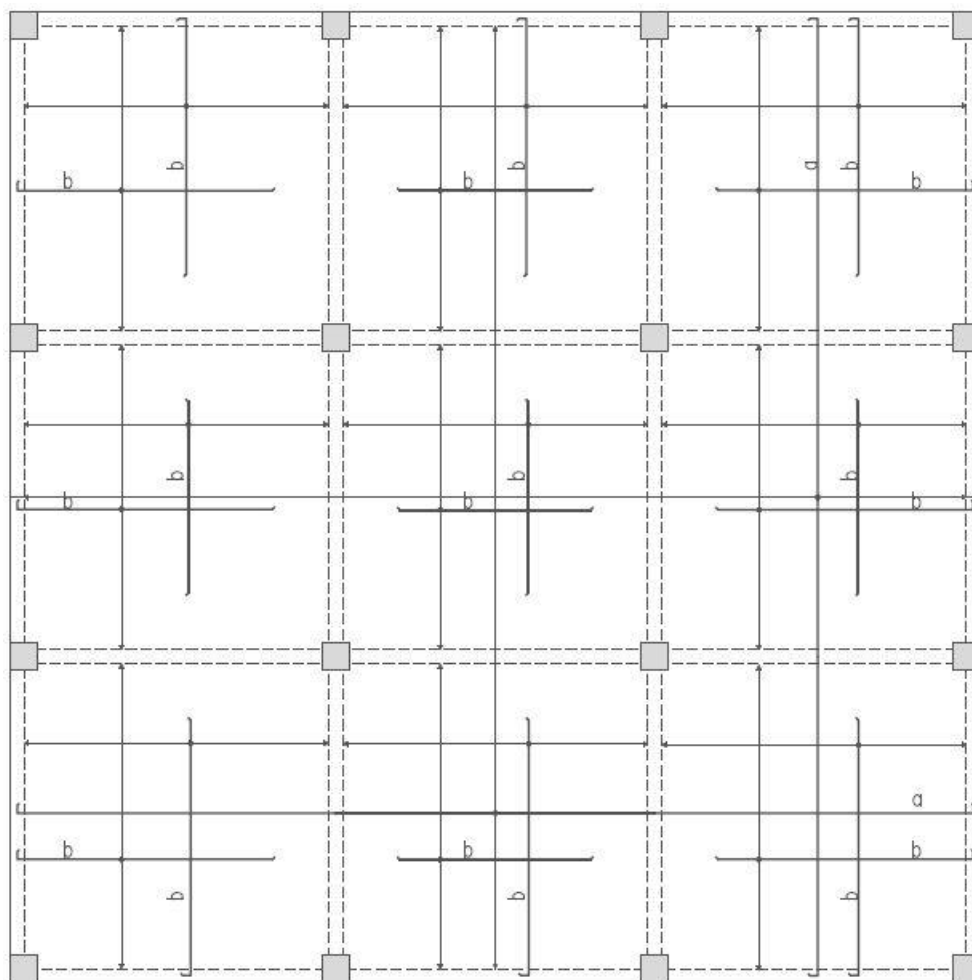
Pormenorização de laje de acordo com o EC2 para as armaduras inferiores
